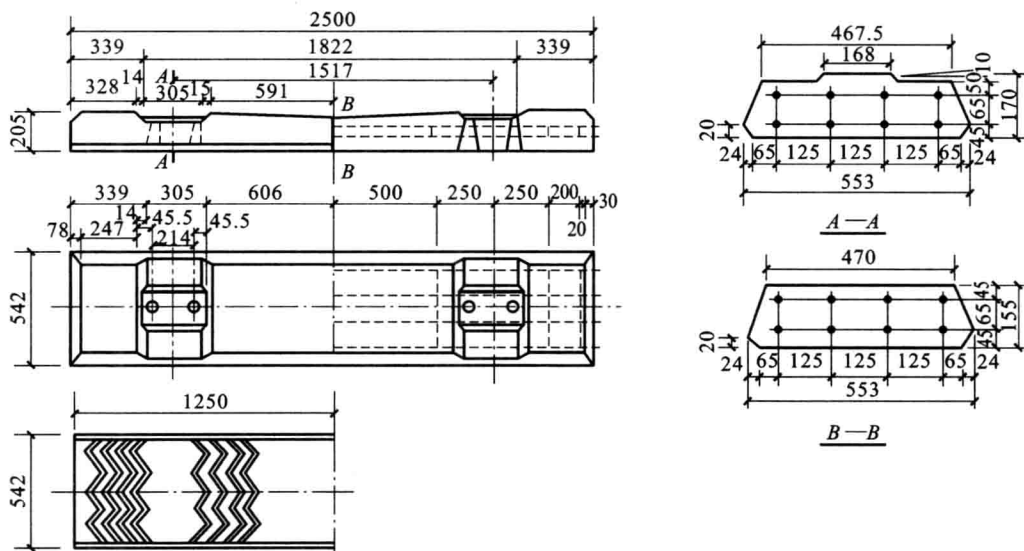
“筋-82”预应力钢筋混凝土宽枕(单位:mm)
